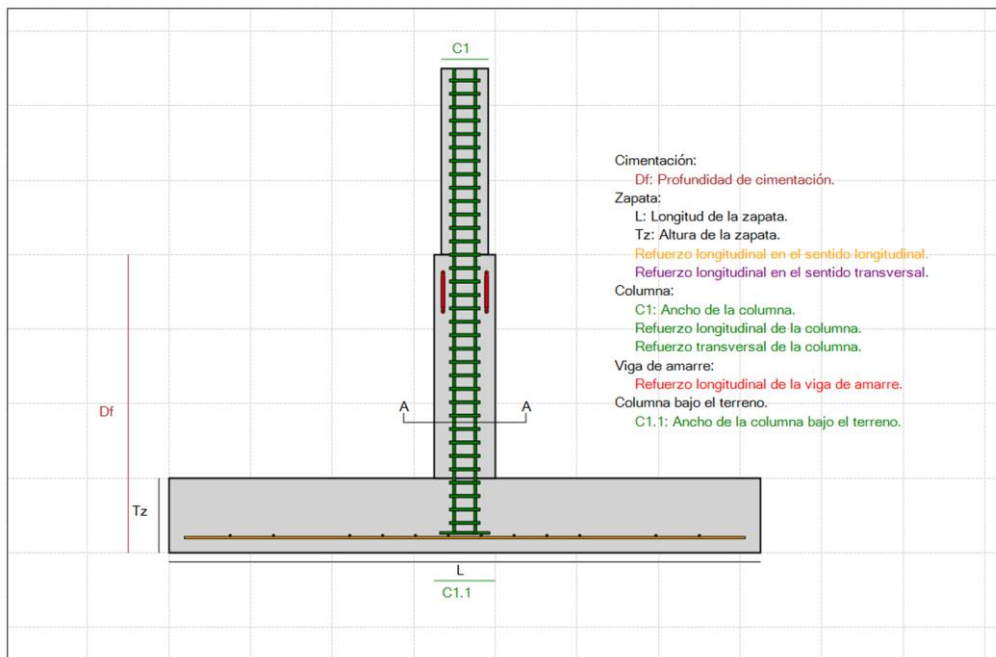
Caso 2 de la cimentación realizada en Revit.
